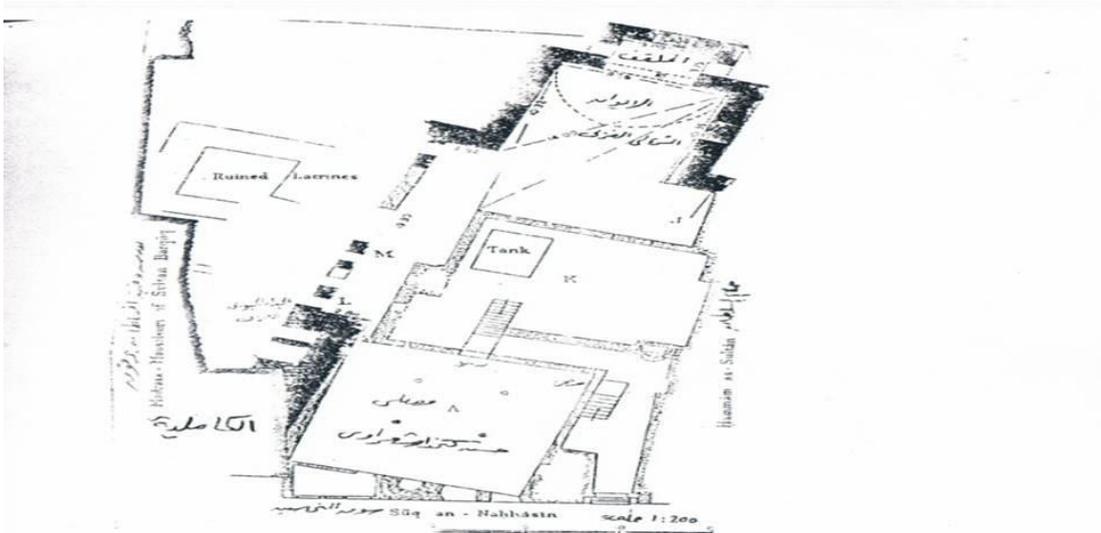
قاعة الأمير، مسقط أفقي وقطع
